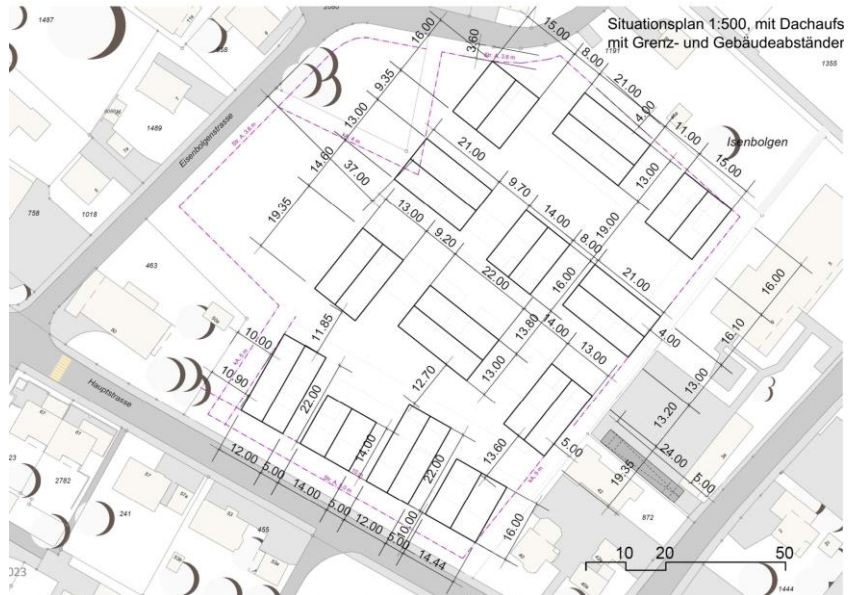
Situationsplan mit Dachaufsicht und Grenz- sowie Gebäudeabständen
